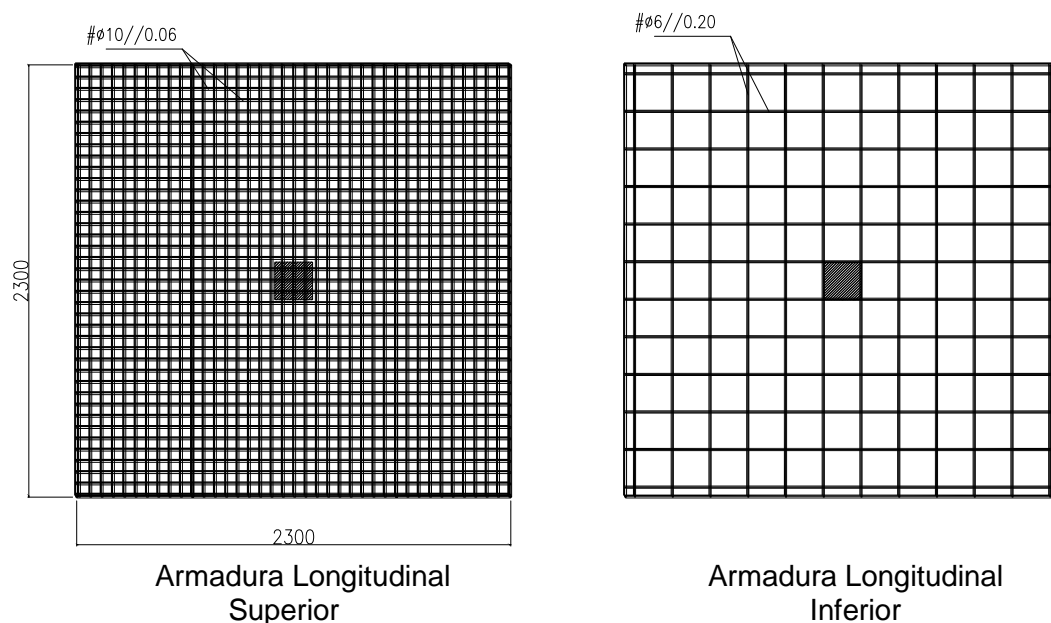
Armaduras longitudinais dos modelos DF1 a DF3 (desenho sem escala e dimensões em mm).
